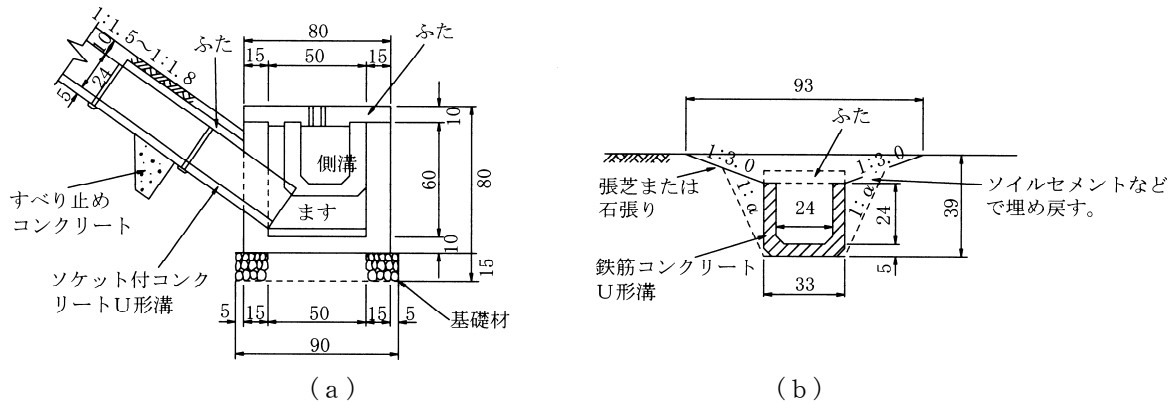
鉄筋コンクリートU形溝による縦排水溝の例 (単位: cm)
